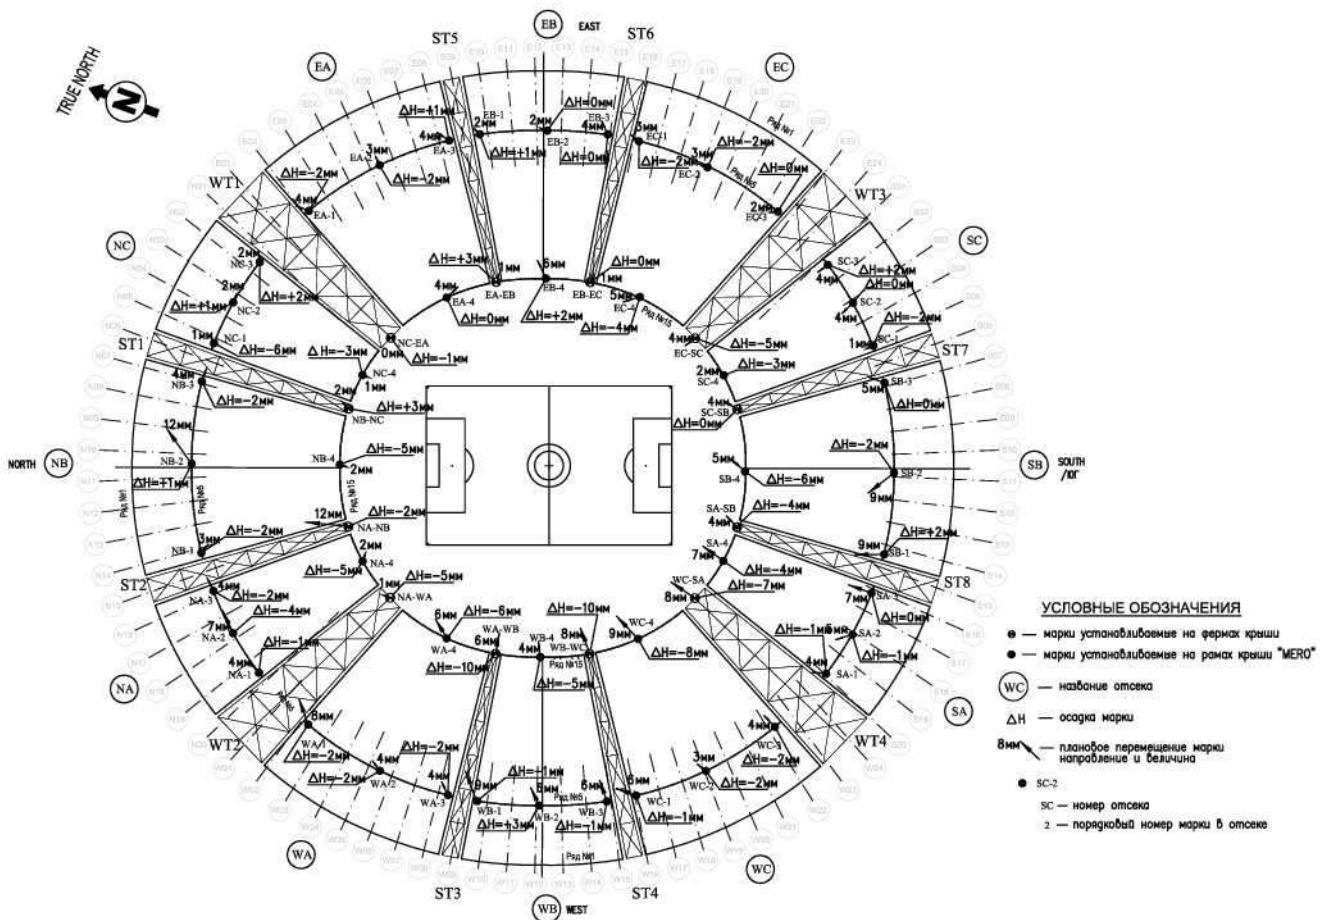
Схема перемещений наблюдательных марок на элементах покрытия
